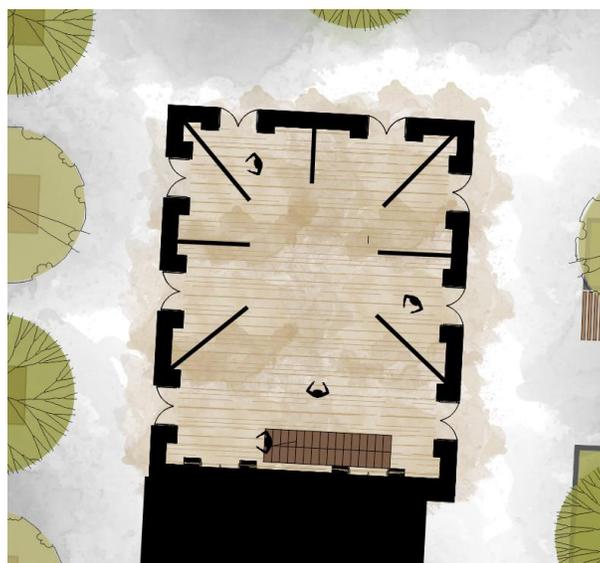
Planta 1 modulo El Triunfo. Autoria propia.
